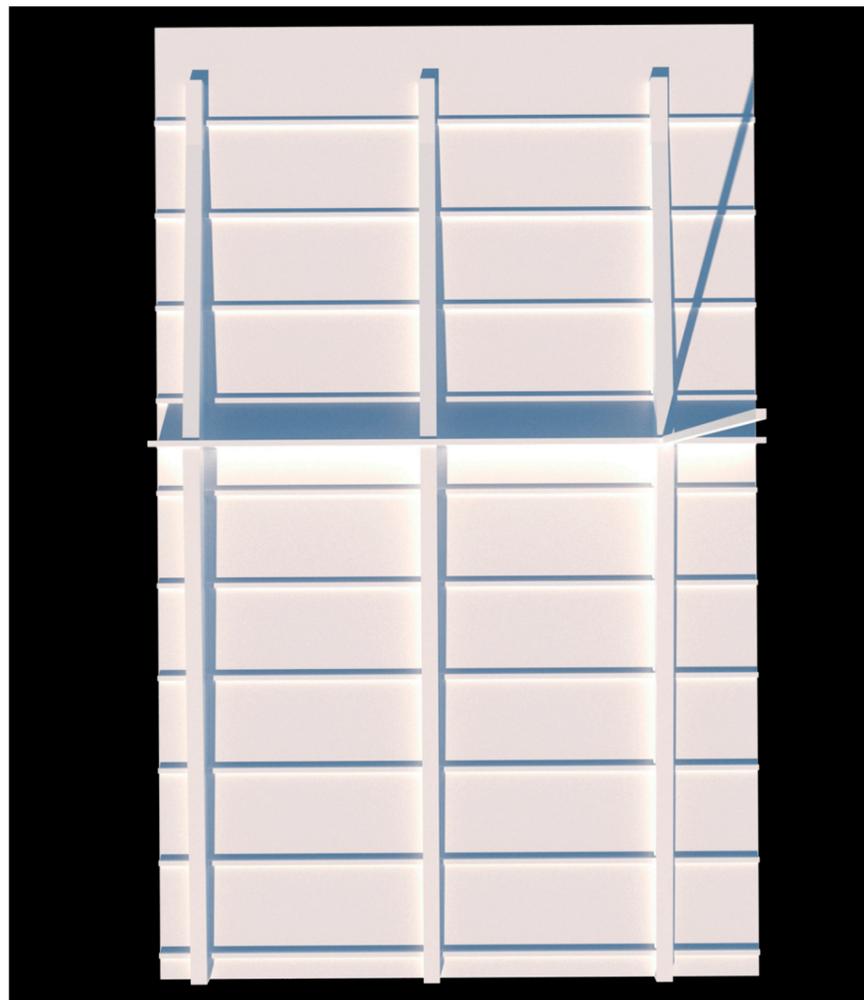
Renderización en planta inferior de la cubierta del actual estadio, donde se aprecian sus elementos. Elaboración propia.
